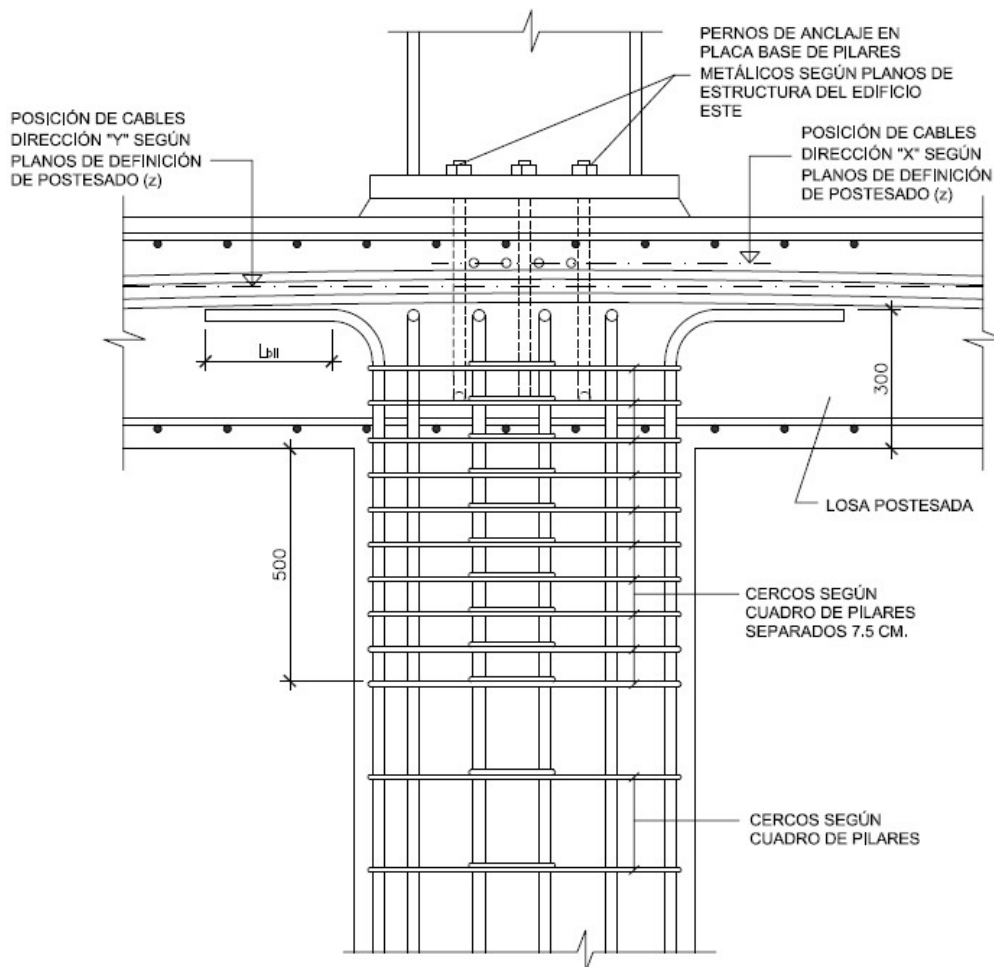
Detalle de armado en transición de pilares de hormigón y metálicos en la losa de Planta Primera.
